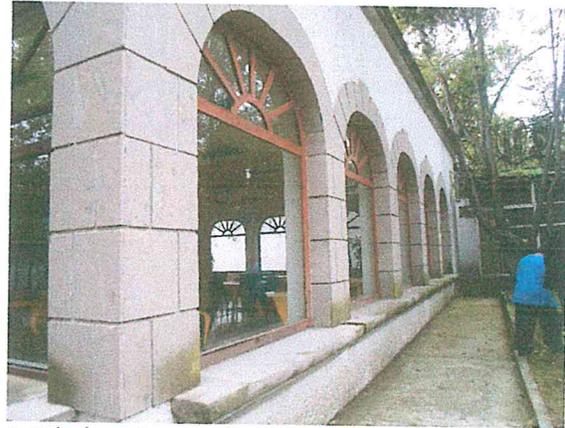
Elementos de la fachada del comedor, en buen estado estructural.
